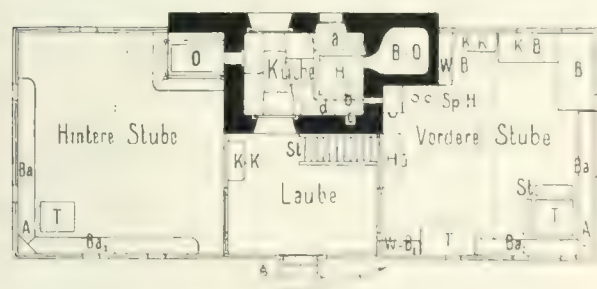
Grundriß des Feilbauer-Hauses. 1:200.
